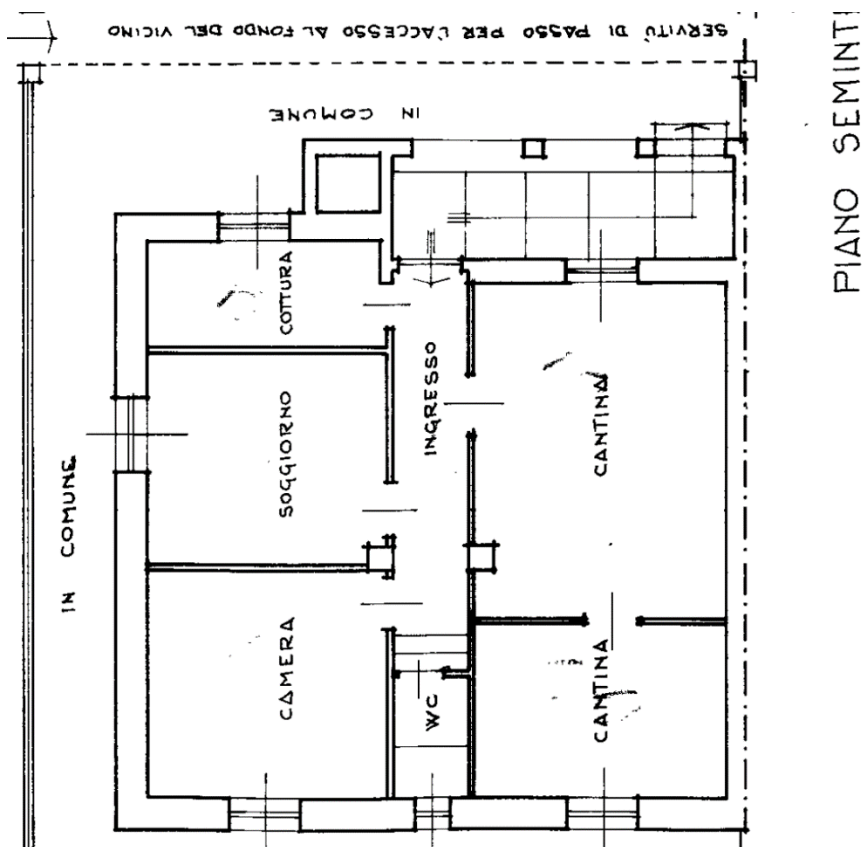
Estratto della planimetria catastale. Pianta piano interrato
